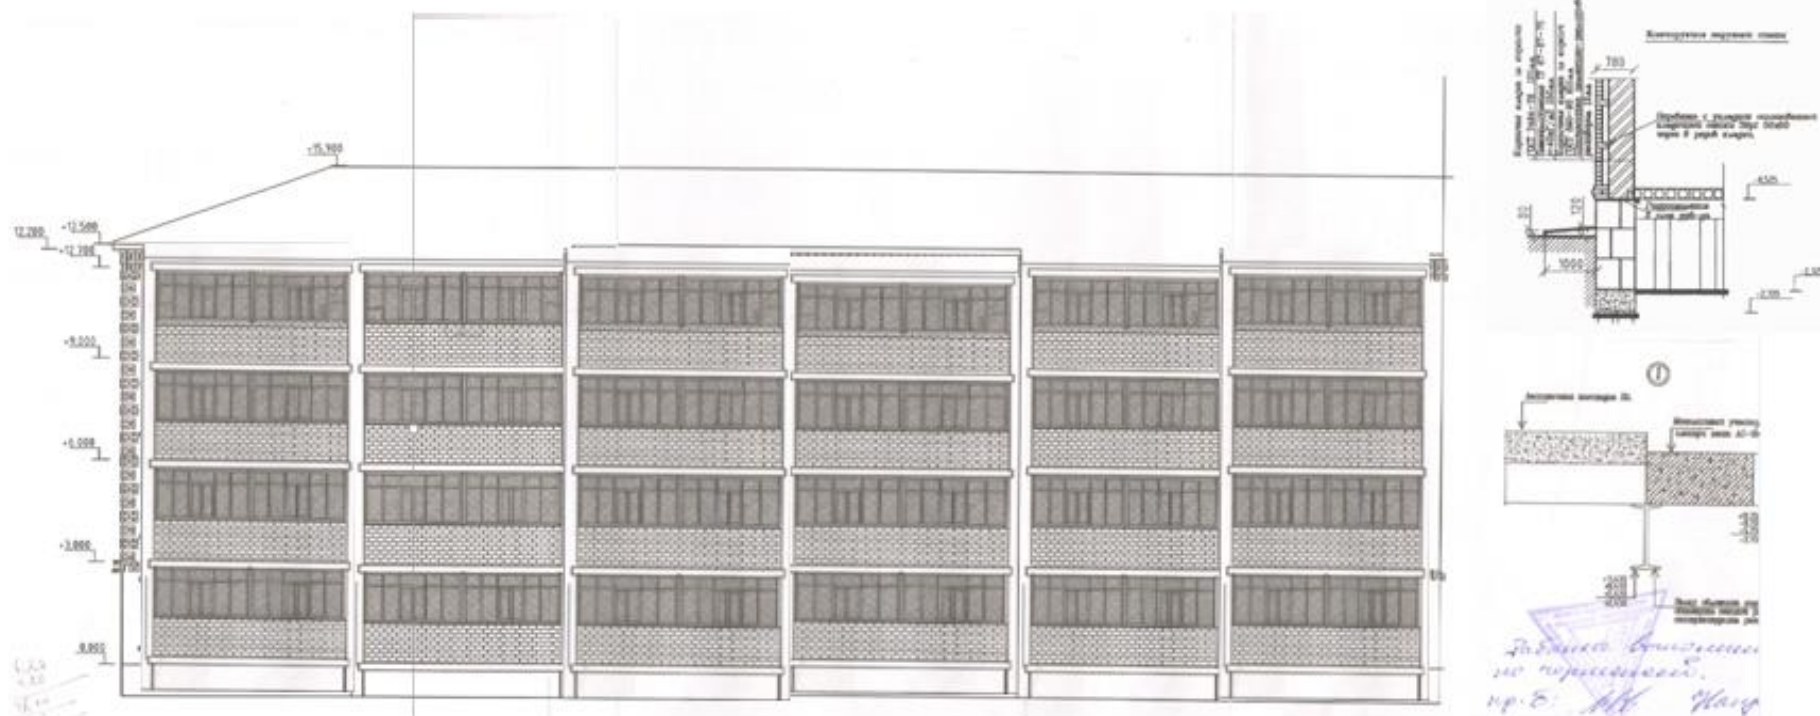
Типовое архитектурное решение фасада дома №24/3 по ул. Магистральная г. Лянтор.
